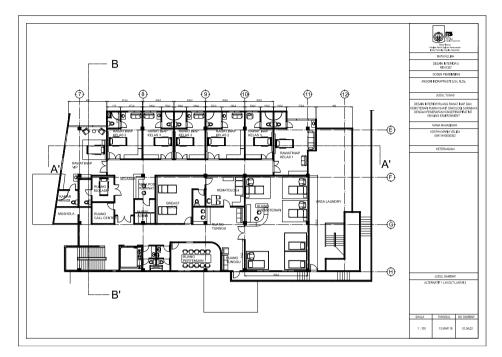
Denah layout Lantai 1 Alternatif 1
